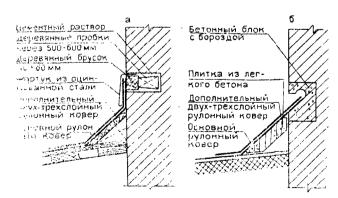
Примыкание кровли к стенам с заделкой дереванного бруста и фартуком; б — с ваделкой в беговный блок
